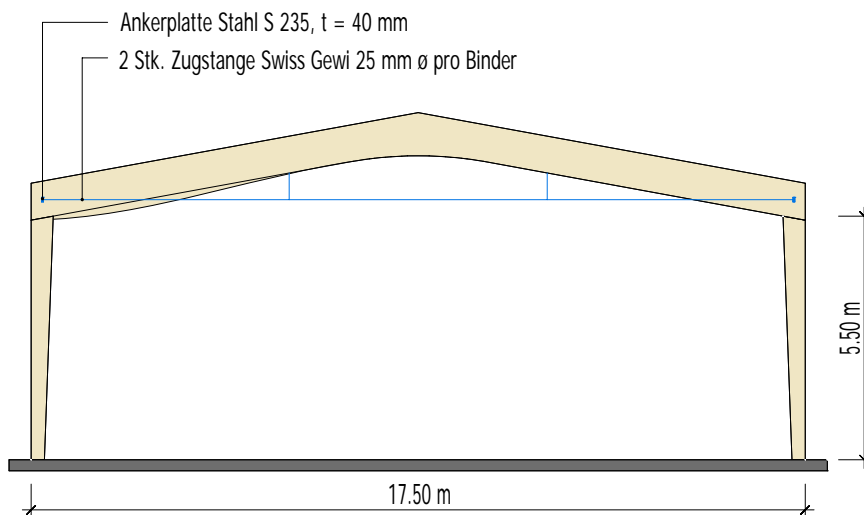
Ertüchtigung eines Satteldachbinders mit dem Einbau von Zugbändern.
